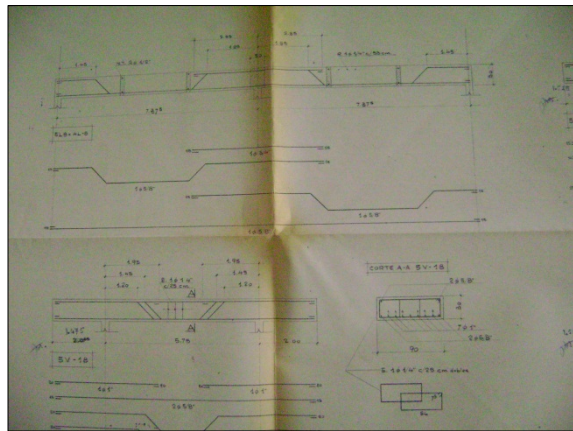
Fotografía de Plano de Estructura de Vigas
